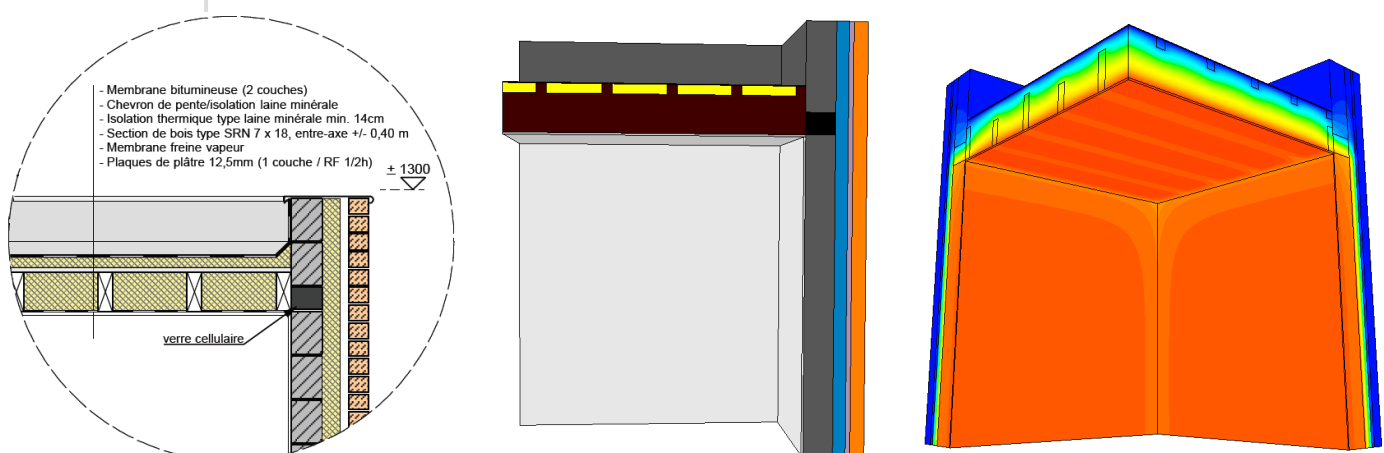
Illustration du nœud 34 formé par l'intersection de deux murs creux, de la toiture plate qu'ils supportent et de l'acrotère.
